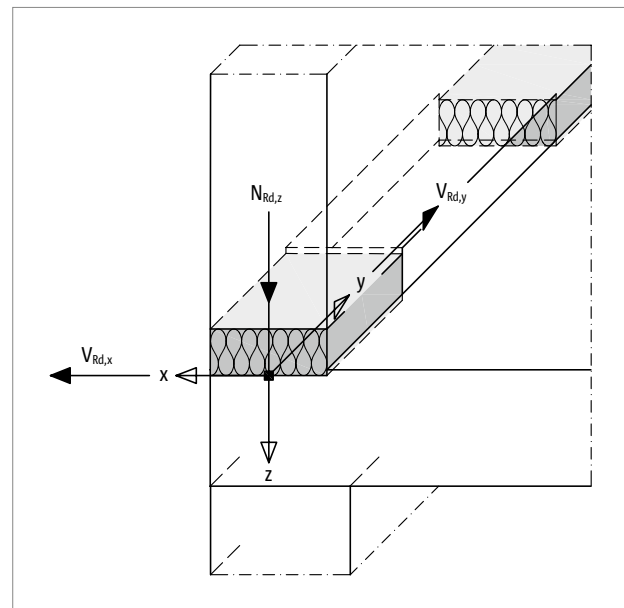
Schöck Sconnex® Typ W: Vorzeichenregel für die Bemessung
